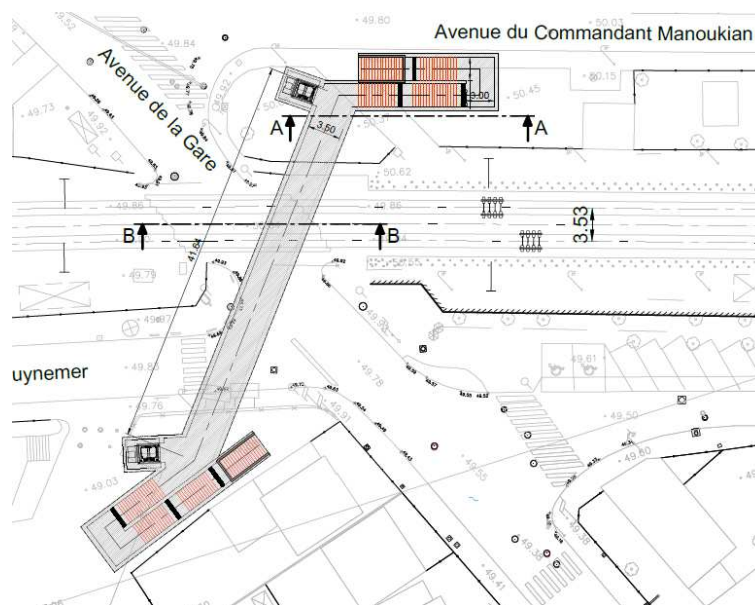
Plan masse et profil de l'ouvrage – source SYSTRA
